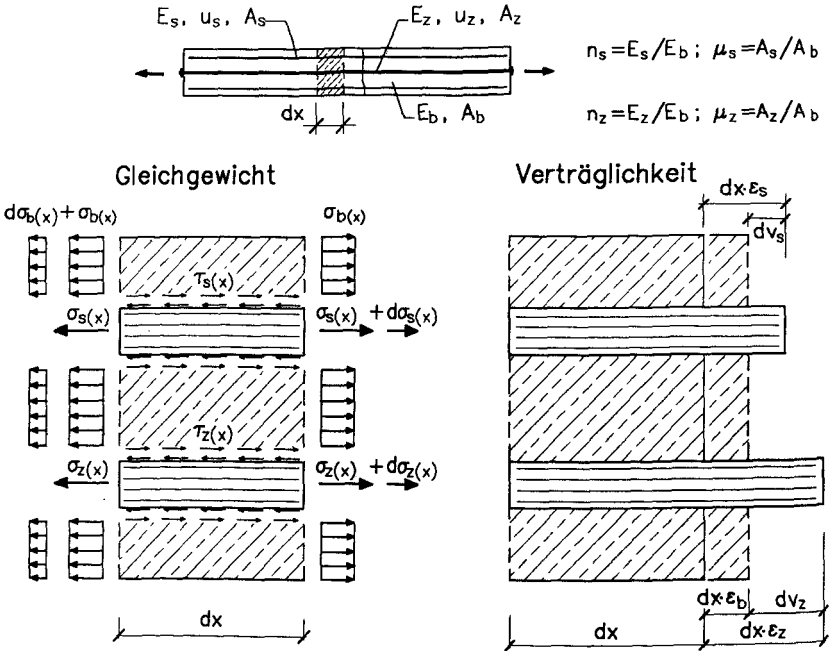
Ableitung der Differentialgleichung des verschieblichen Verbundes am auf Zug beanspruchten Stahlbetonelement mit zwei Bewehrungssträngen
